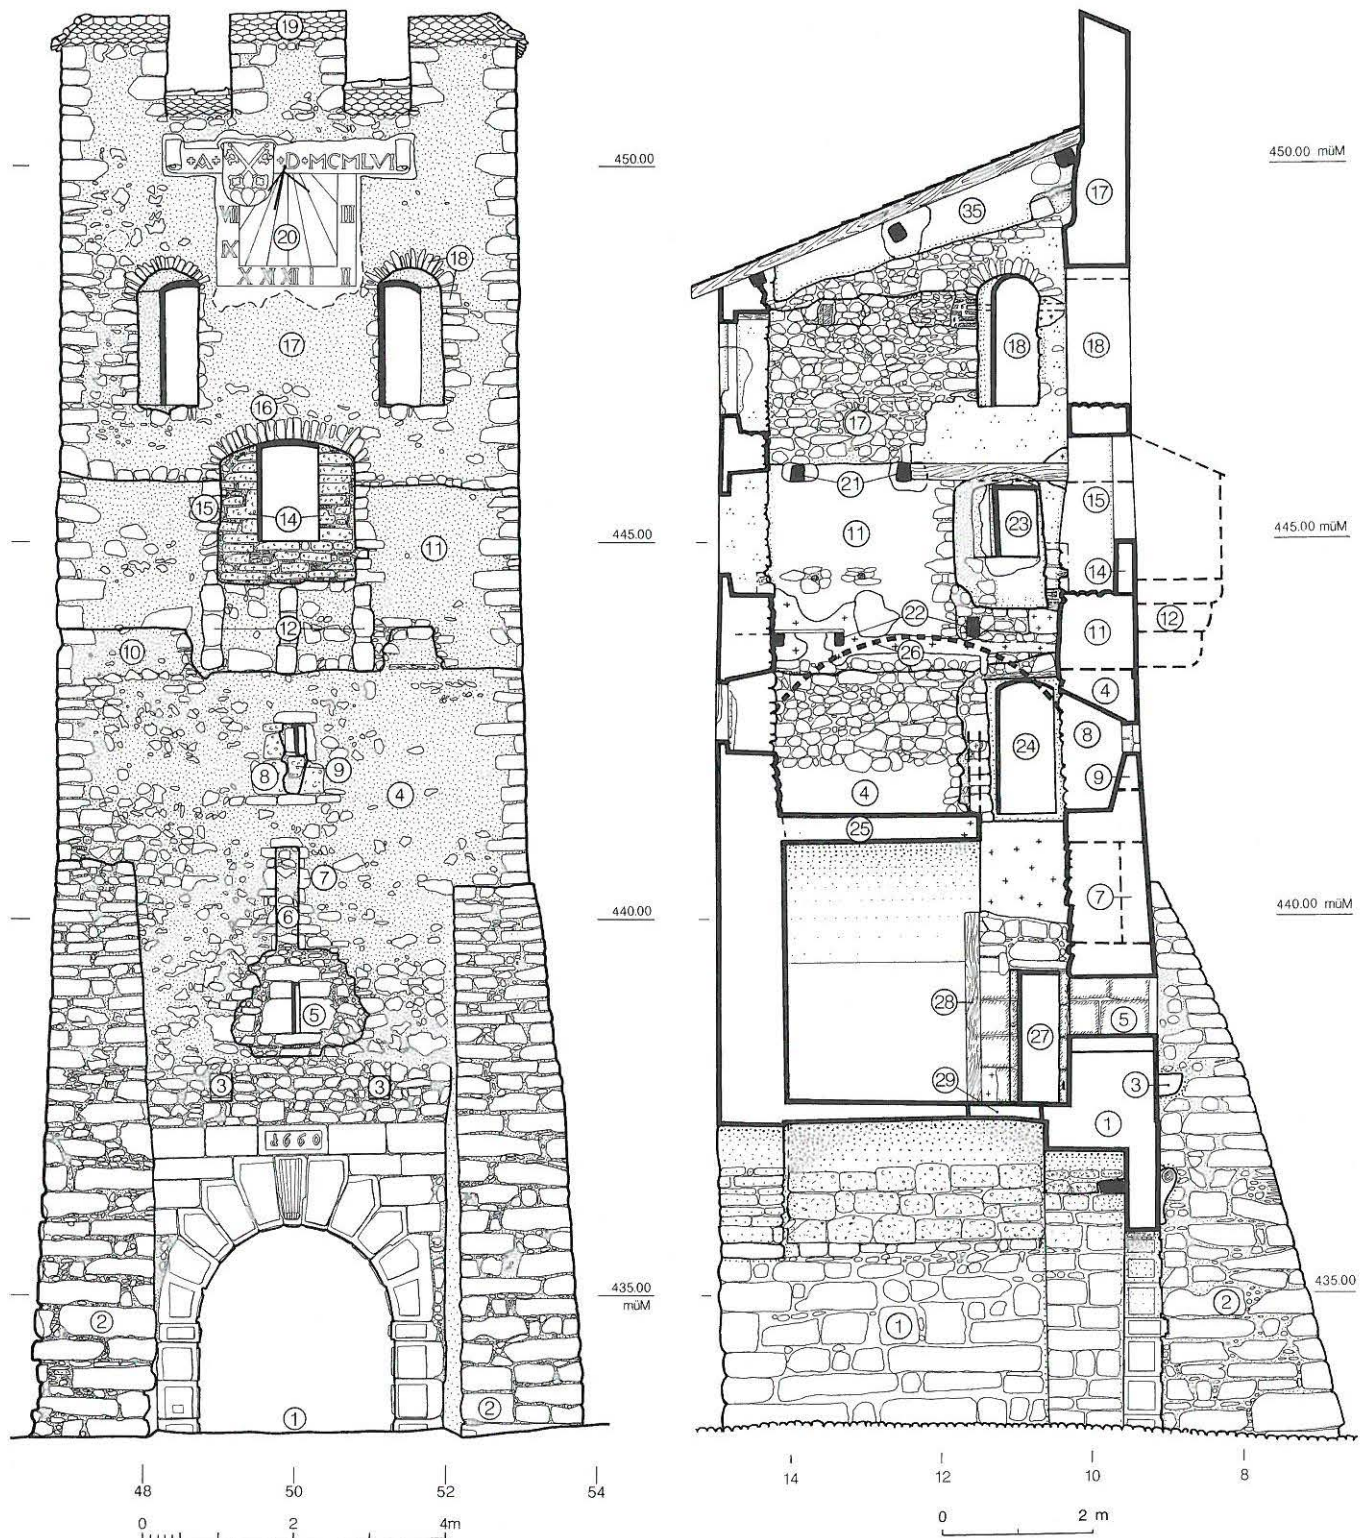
La Neuveville, Tour de Rive. Relevé pierre à pierre de la façade côté lac et coupe vers l’est. Echelle 1:100. Légende voir texte.
